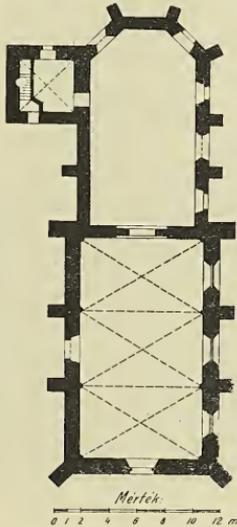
Grundriss der Franziskaner-Kirche zu Köröshegy.
